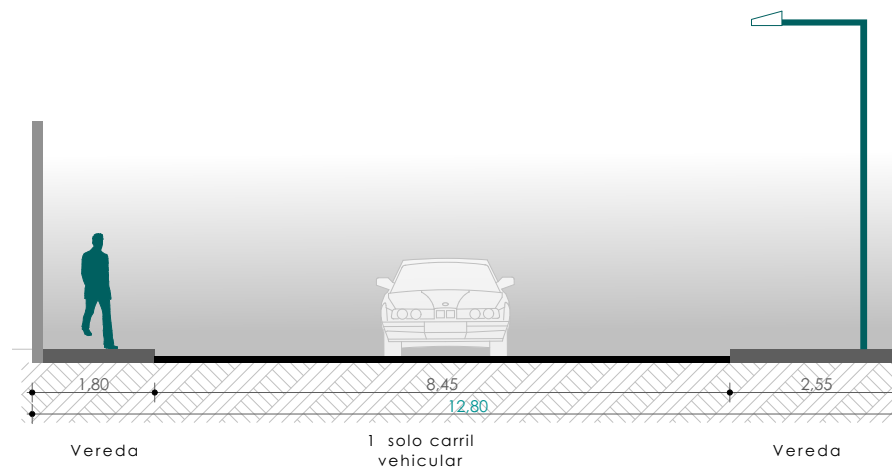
Sección de la calle Benjamín Carrión. Imagen: propia
